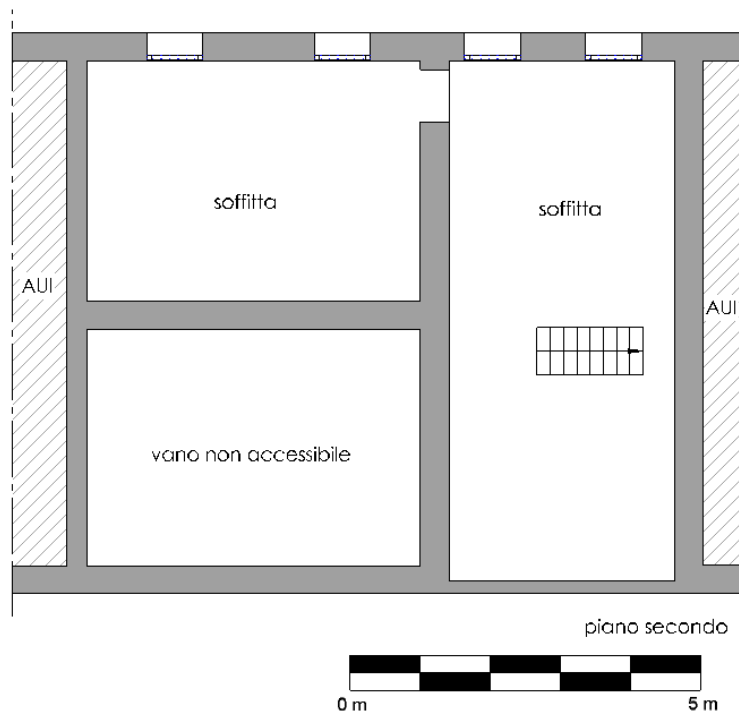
Planimetria piano secondo – ridisegno sommario
